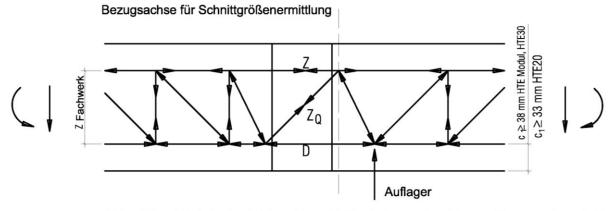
Schöck Isokorb® Typ K und KF mit Betondrucklager (Fachwerkmodell)
